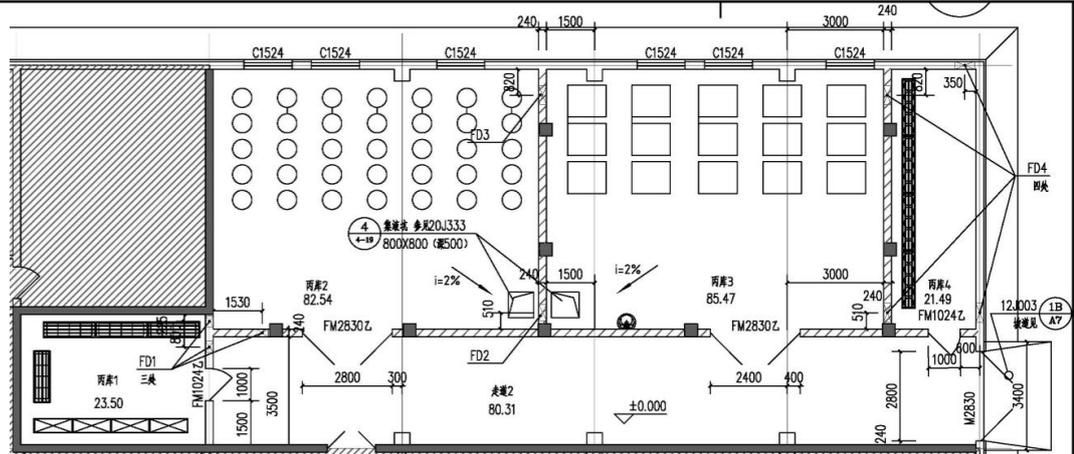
21#厂房局部丙类危险化学品暂存库平面布置图
